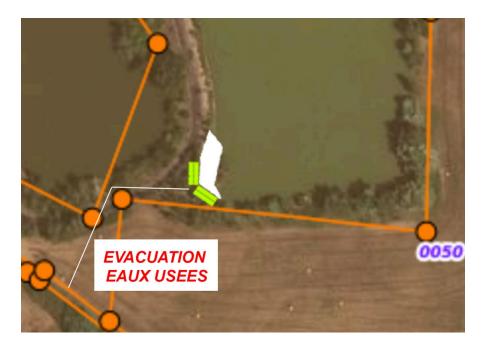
Plan de l'évacuation des eaux usées, source : porteur de projet
